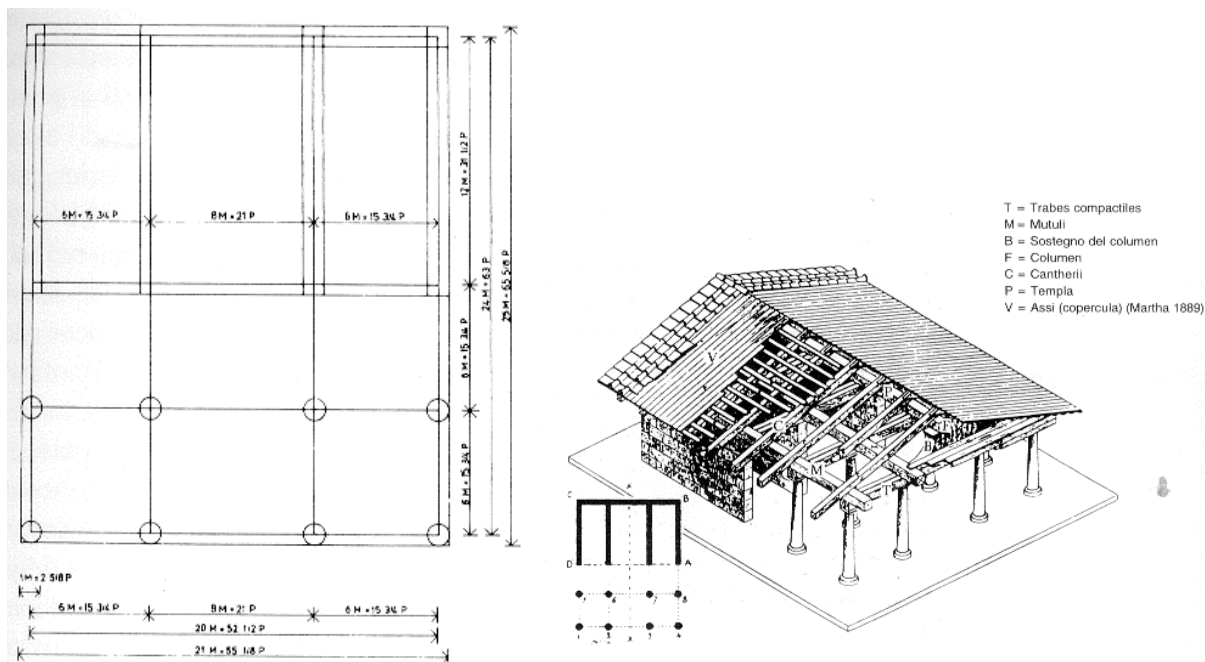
Pianta e ricostruzione del tempio tuscanico secondo Vitruvio. Da GROS 1996.
